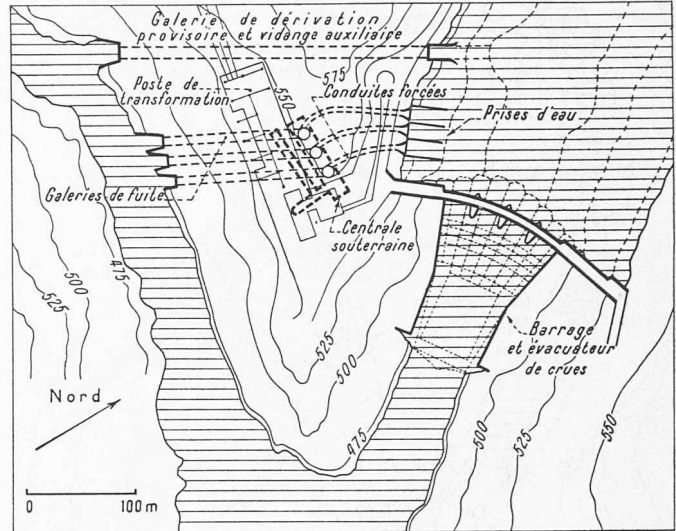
Lageplan des Kraftwerks Miranda 1:7000
